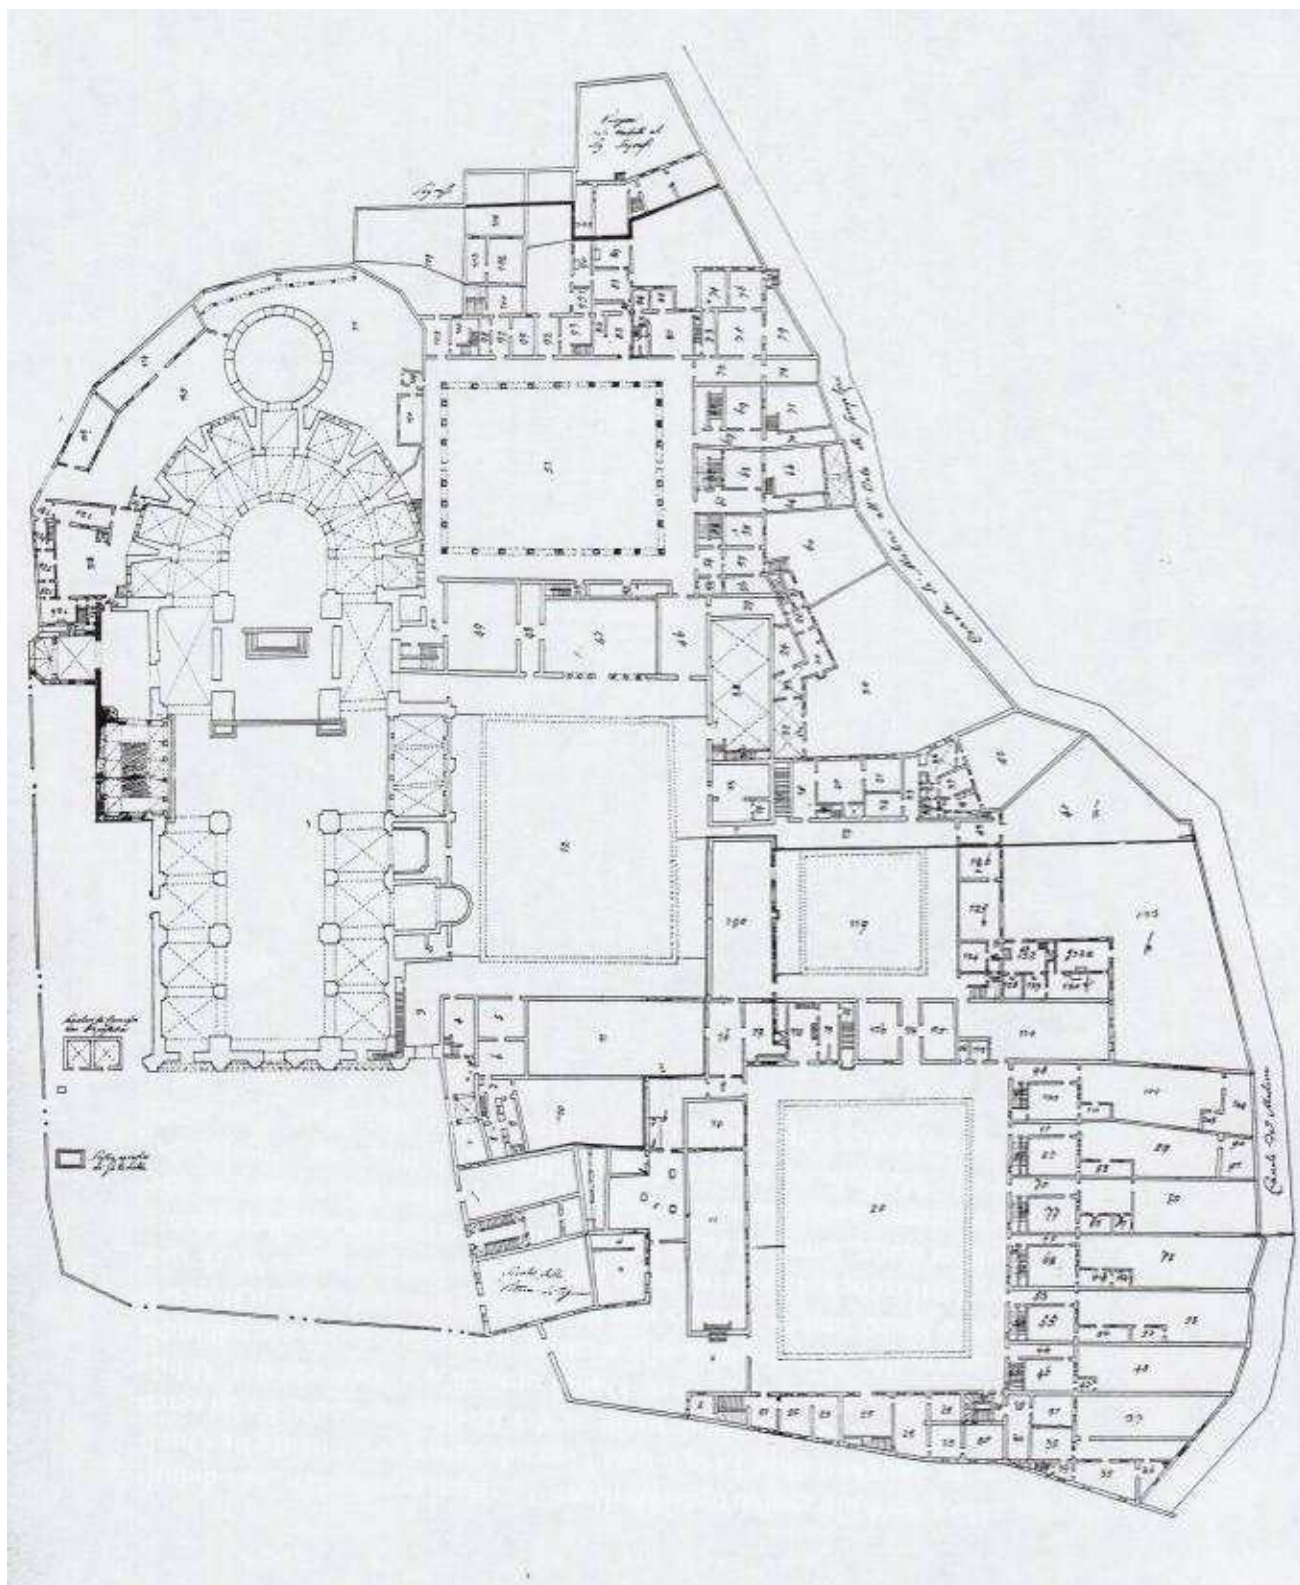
Padova, convento di Sant'Antonio, pianta (inizio XIX secolo)
